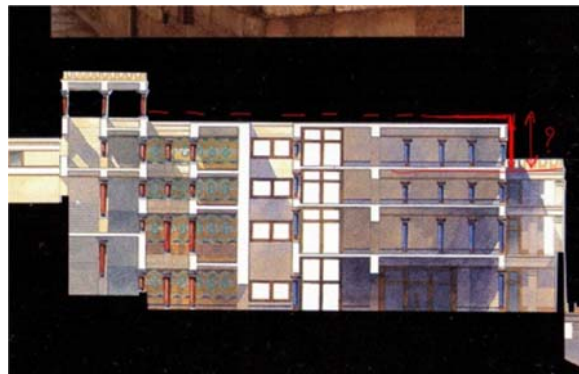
Coupe Est-Ouest au niveau du bâtiment du hall aux doubles haches
